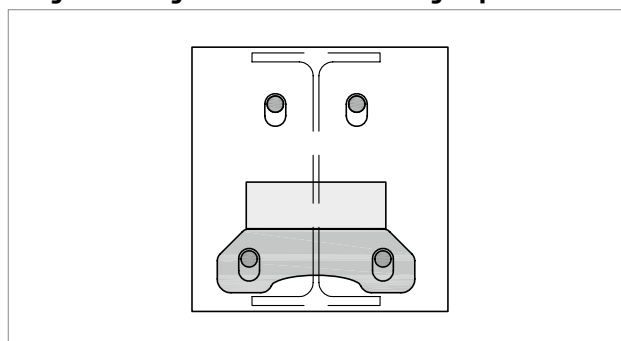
Schöck Isokorb®: verdraaide en verschoven elementen door gebrekkige zekering tijdens het betonneren.
